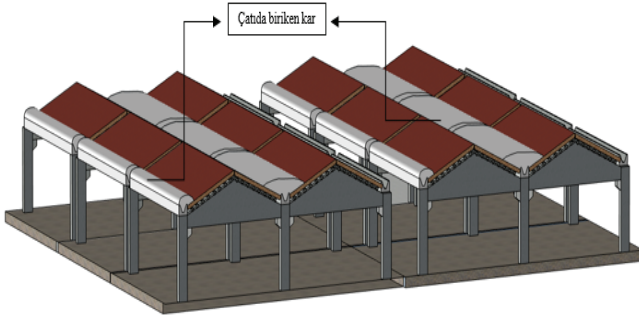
Tipik prefabrik sanayi yapısı örneği
